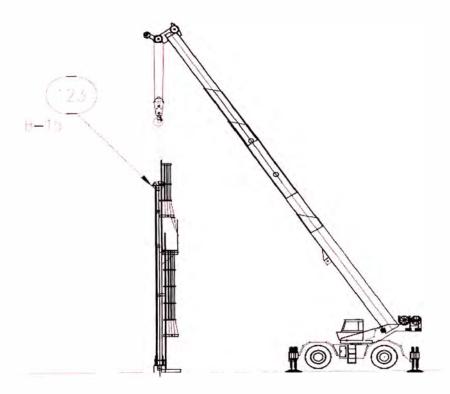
Posición de equipos para maniobra de montaje de la cepa B15
